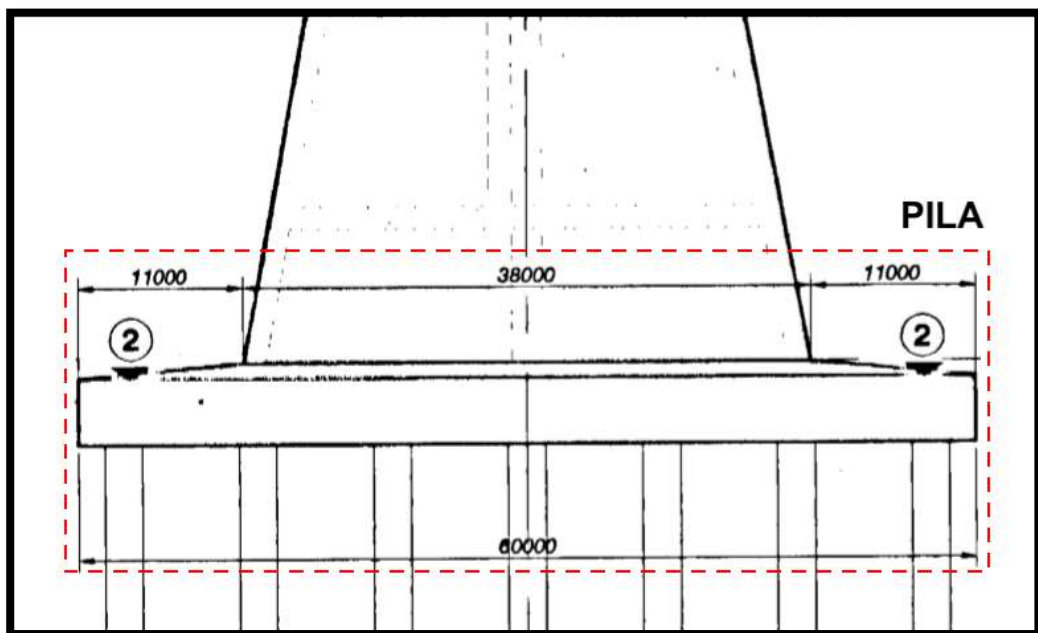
Ancho de la pila de los pilotes (T2/T3) a ser hincados
